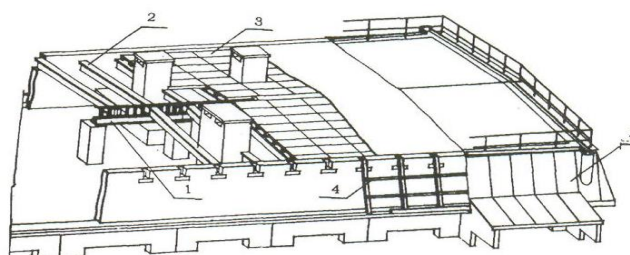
Реконструкция плоской кровли в чердачную с использованием сборных железобетонных элементов:
